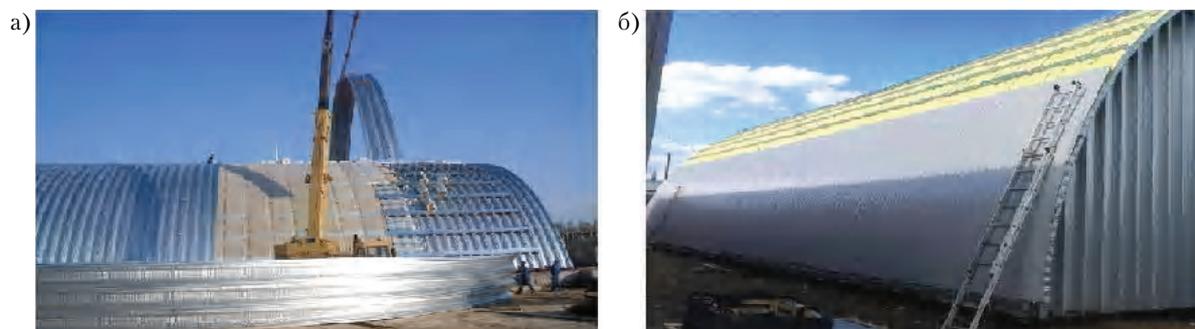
Варианты наружного утепления бескаркасных сводчатых покрытий: а) утепление методом устройства двойной арки; б) внешнее утепление минераловатными плитами с устройством внешней гидроизоляционной оболочки.
